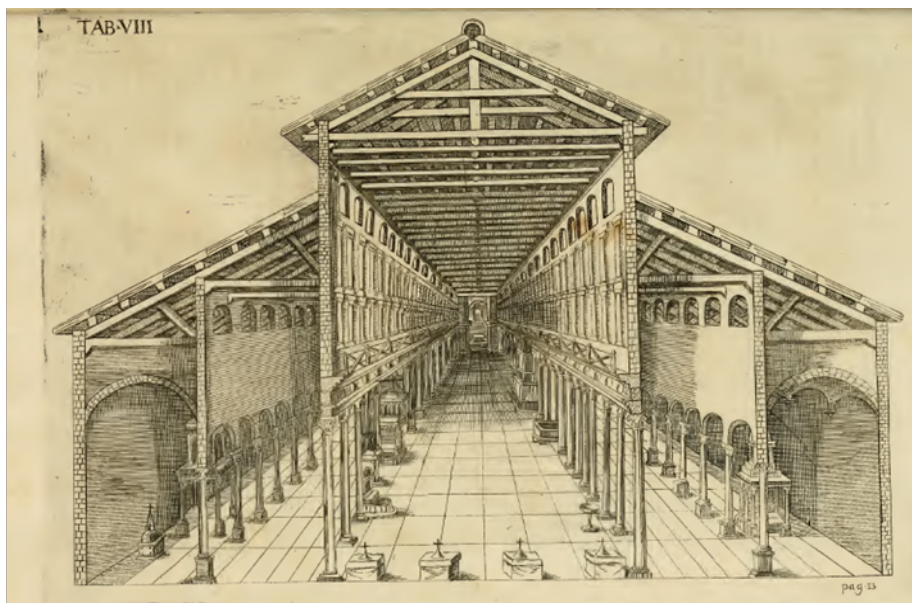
Sección de la antigua basílica, según J. Cimpiani (1693)
